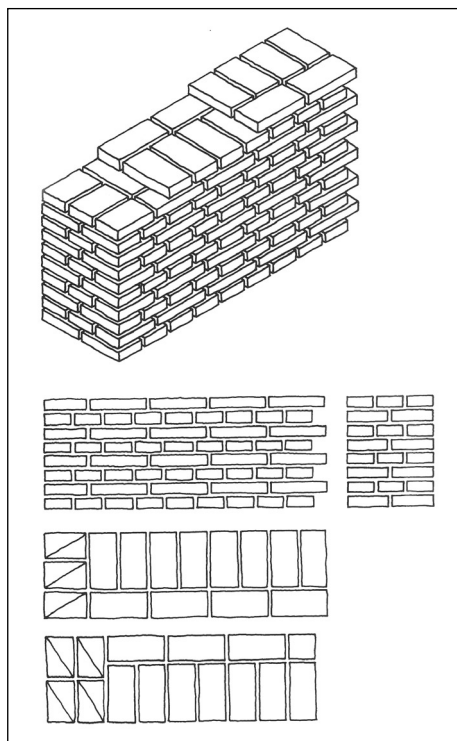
Muro a tre teste concatenato a blocco. Veduta assonometrica, prospetto, sezione e pianta dei corsi di mattoni (Immagine tratta da A. Acocella, *L'Architettura del Mattone faccia a vista*, Roma 1989.)
